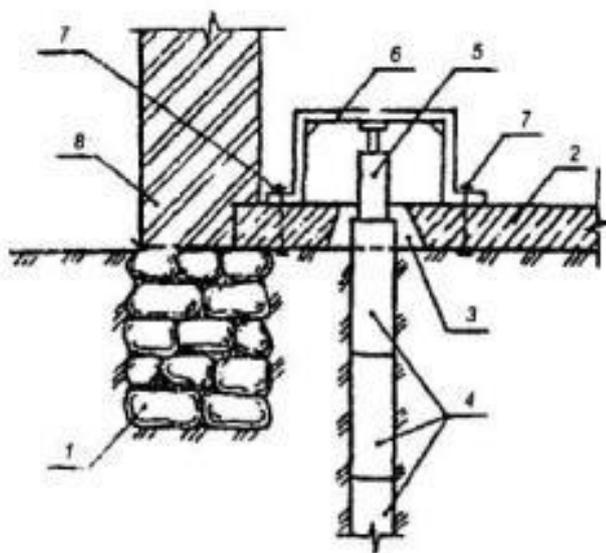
1 - усиливаемый ленточный фундамент; 2 - монолитная железобетонная плита; 3 - отверстие в плите, устраиваемое при ее бетонировании; 4 - звенья составной железобетонной сваи; 5 - гидравлический домкрат с длинным штоком; 6 - металлический упор; 7 - анкерные болты; 8 - кирпичная стена.
